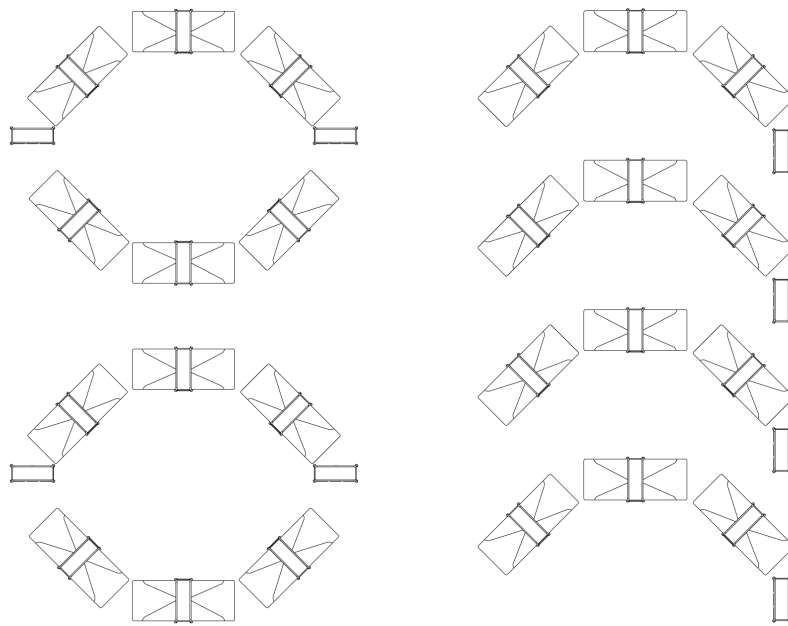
Tipos de distribución en planta del Cmax System. Elaboración: Autores.
